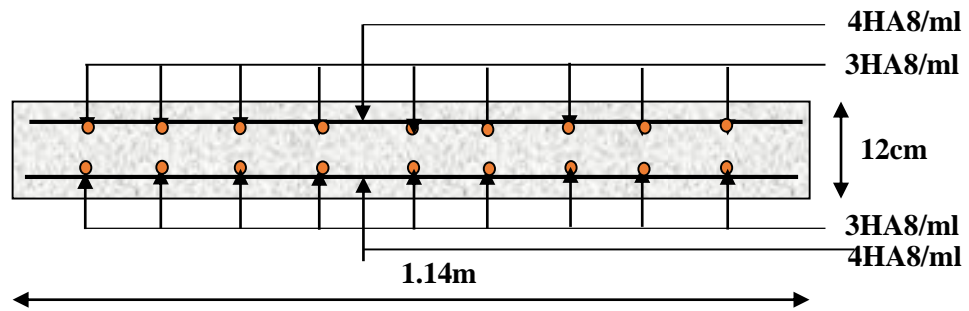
Schéma de ferrailage de la dalle pleine type N° 2.
